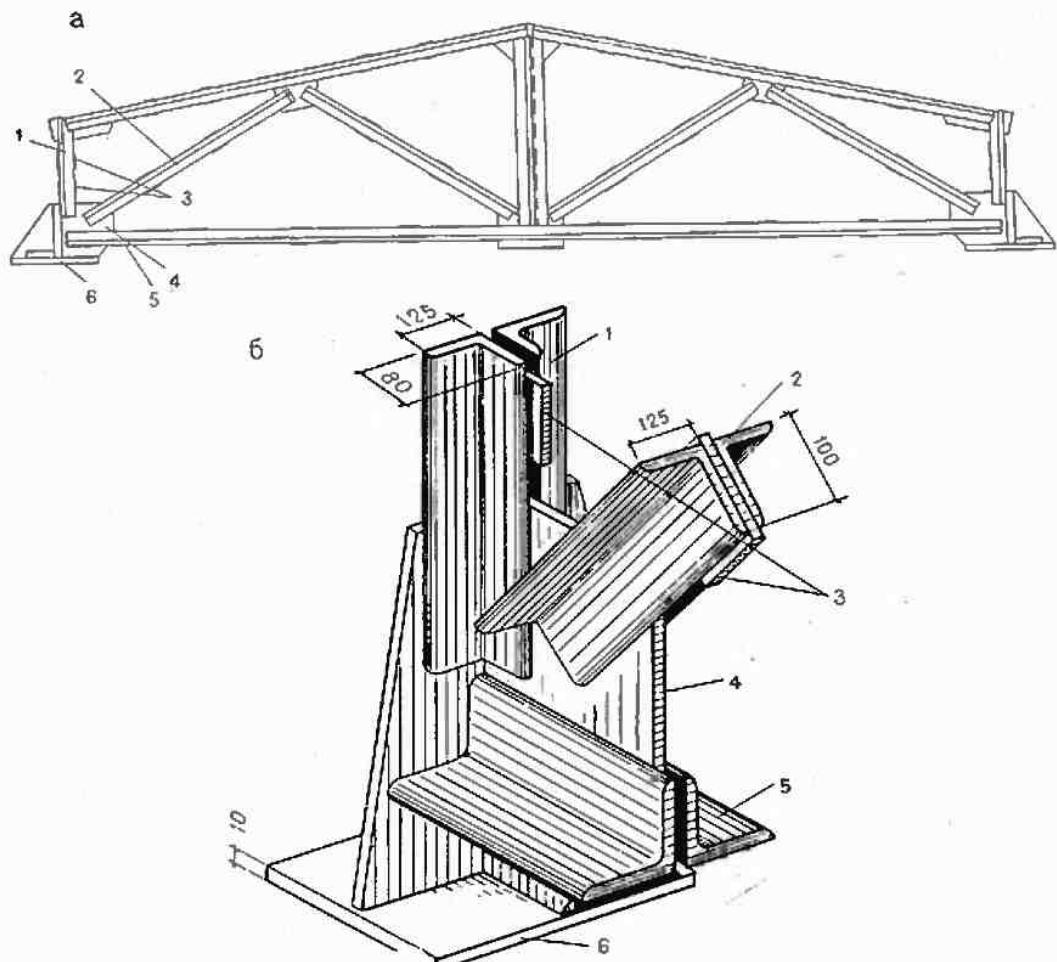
Полигональная стальная ферма и деталь опорного узла (сварные швы условно не показаны)
